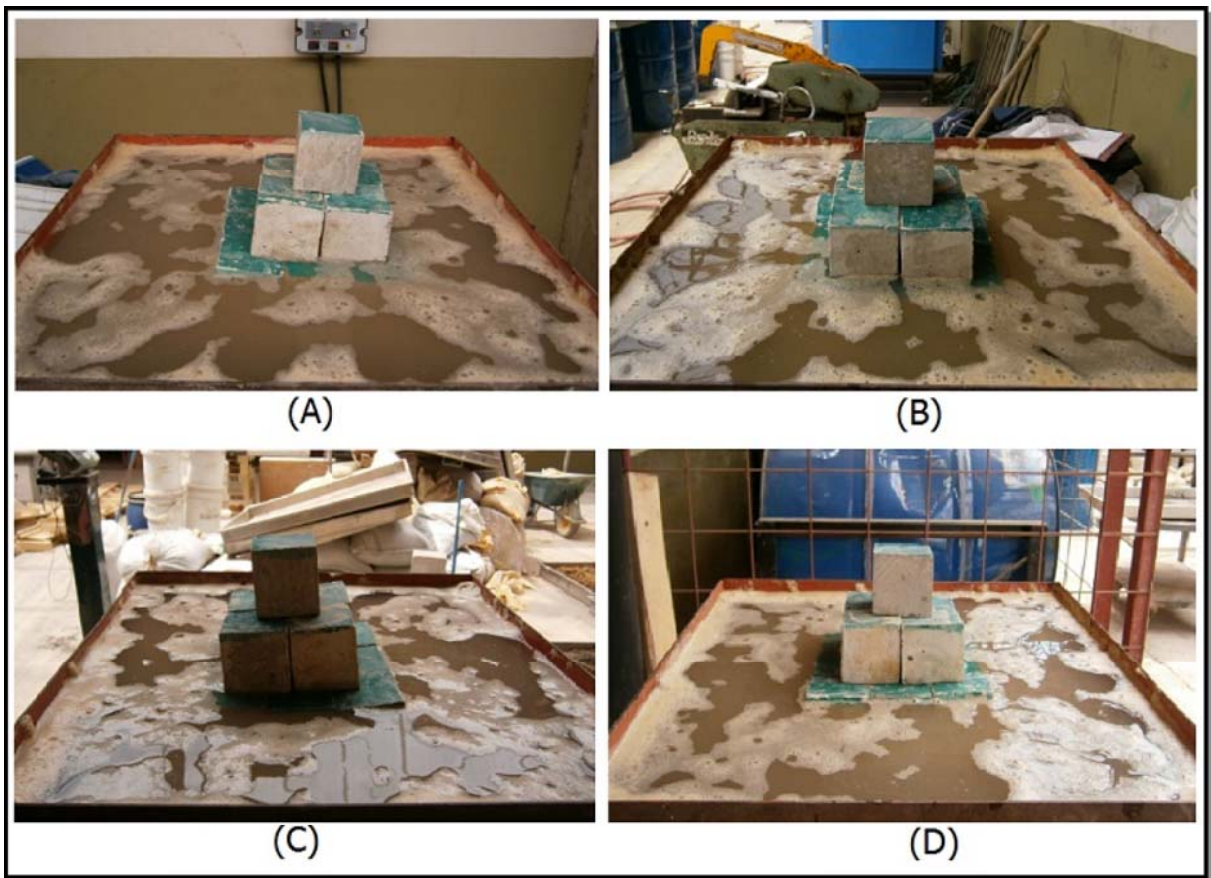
Resultado del modelo a escala con arena de playa 100%. (A) Fachada norte, (B) fachada este, (C) fachada sur, (D) fachada oeste
